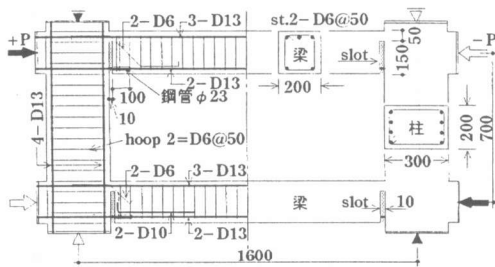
試験体(SL-FRAME)の形状、寸法、配筋等
